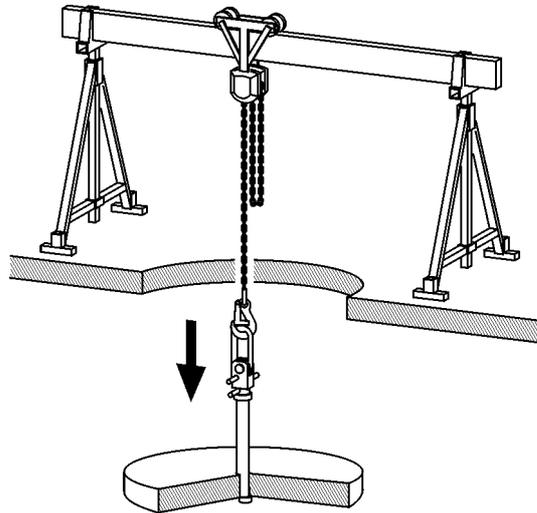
Ausbauvorrichtung am Beispiel einer Boden-Grosslochkernbohrung
